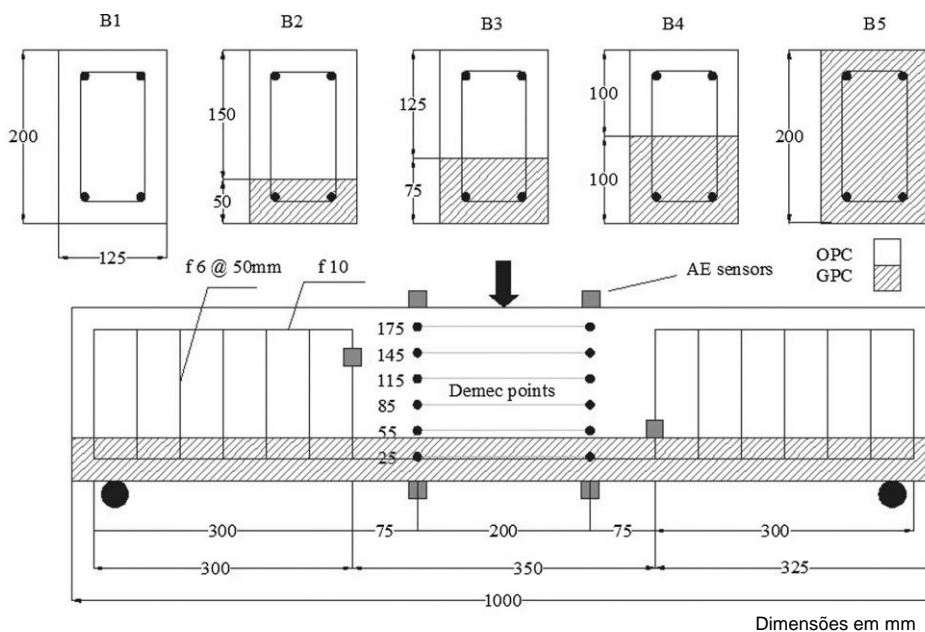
Configuração das vigas confeccionadas por Ranjbar *et al.* (2016).
